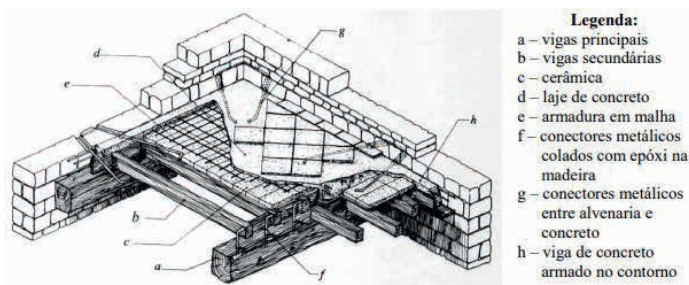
Aplicação de estrutura mista em concreto/madeira
